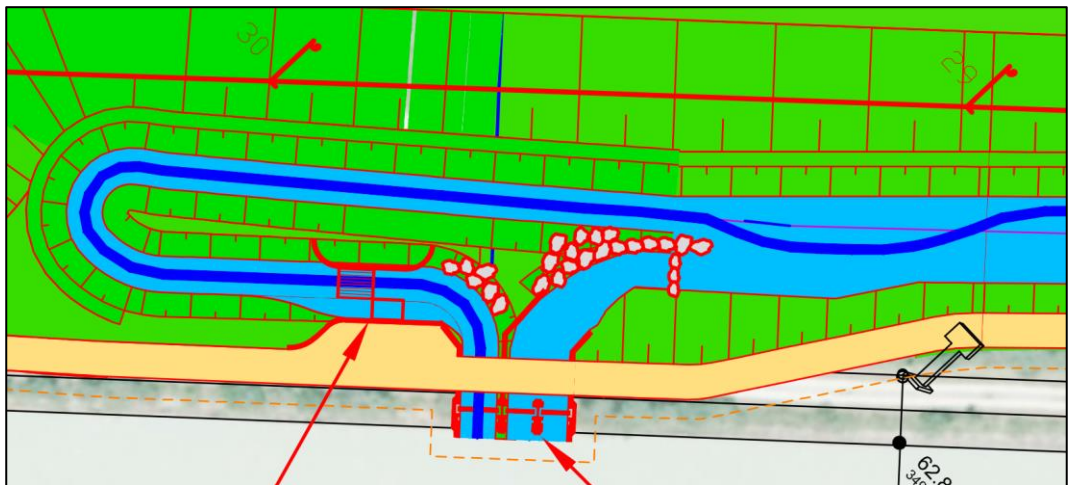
Lageplanausschnitt des Ausstiegsbauwerks (aus technischem Erläuterungsbericht (WERNER CONSULT 28.08.2020))
